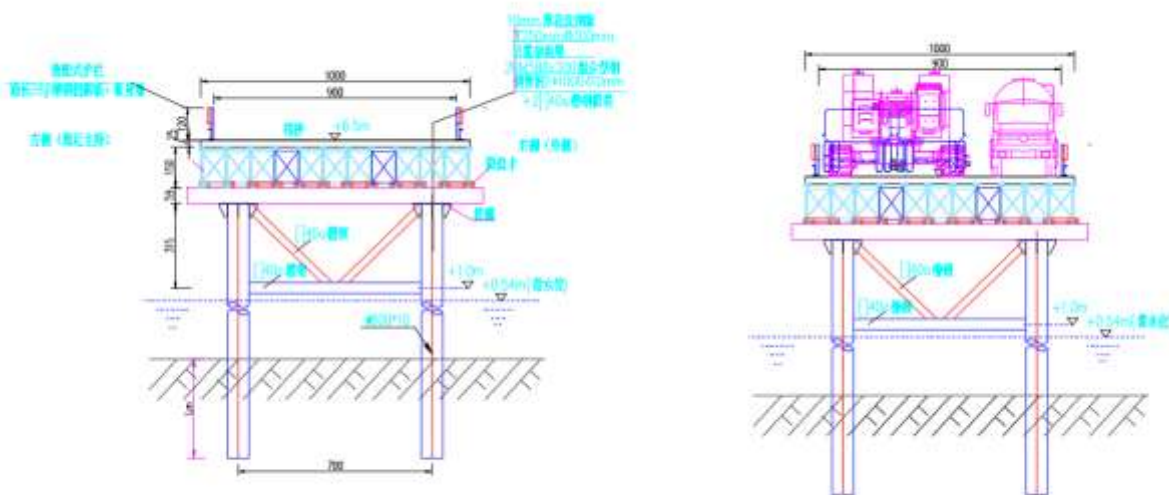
江门侧 3 号栈桥横立面图 (桥宽 9m)
